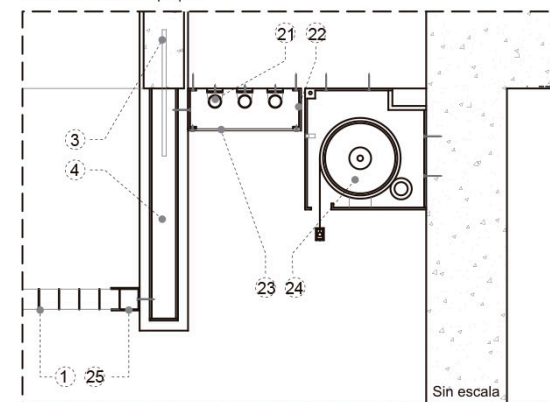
Detalle corte empate de tumbado en perímetro de salón múltiple.
